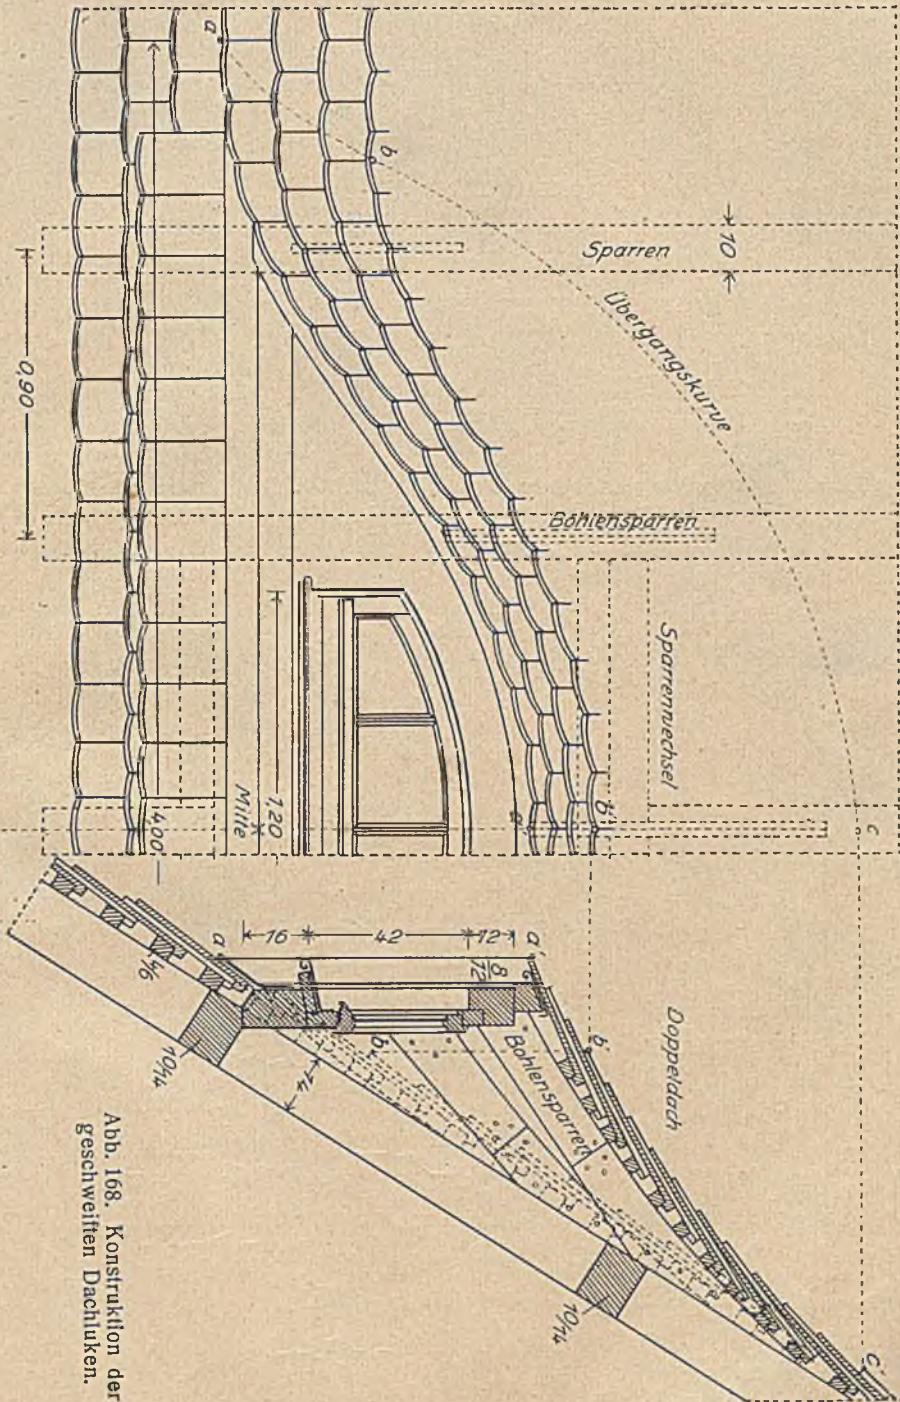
Konstruktion der geschweiften Dachlaken.
